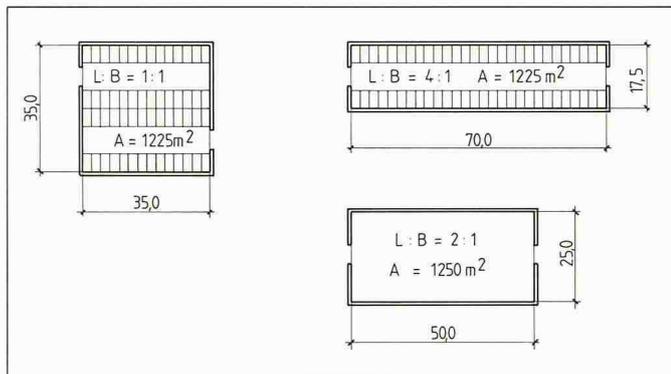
Die Parameterstudie für offen gebaute Parkhäuser umfasst neben den in Bild 2 dargestellten Grundrissen auch 3 Parkhäuser mit etwa gleicher Grundrissfläche, aber unterschiedlicher Geometrie
